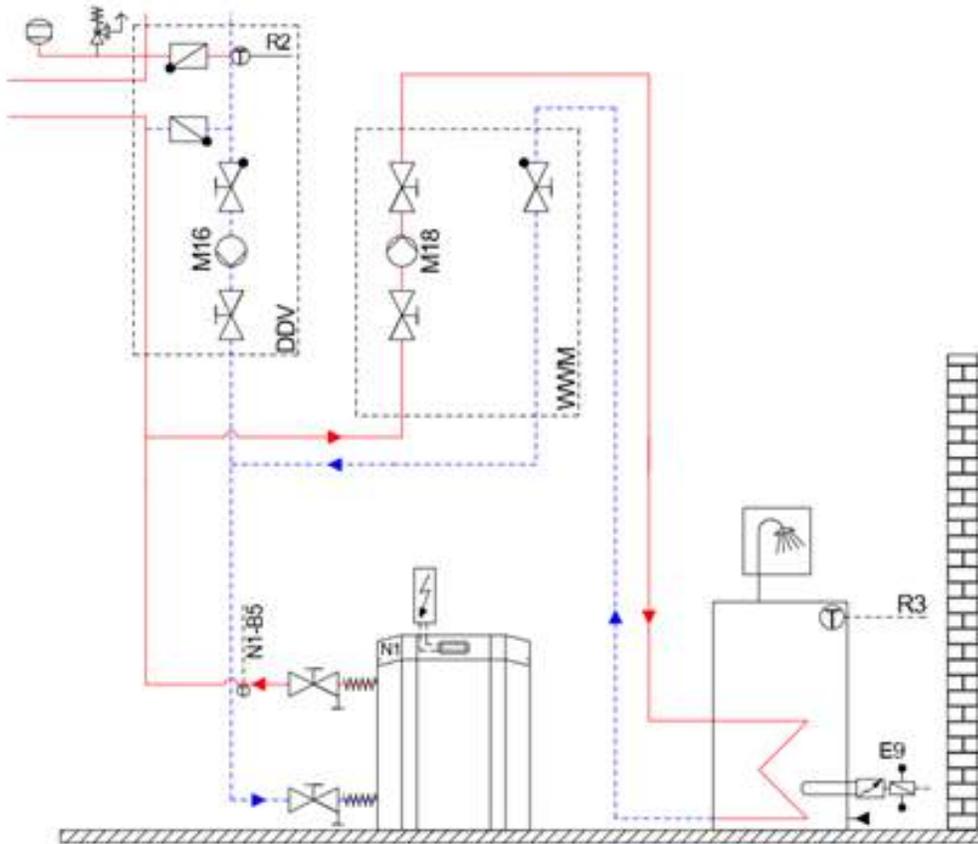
Warmwasserbereitung über Umwälzpumpe M 18 mit Rückschlagklappen im Erzeuger- und Warmwasserkreis
